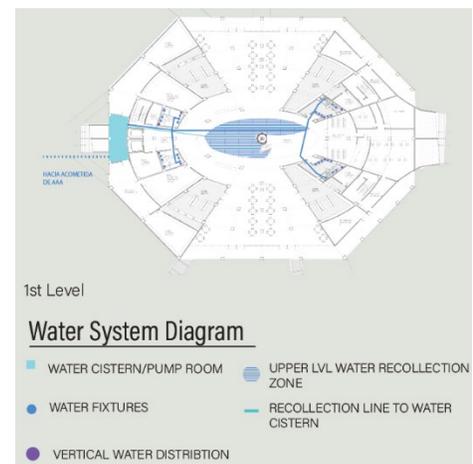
Diagrama planta primer nivel con localización de cisterna, trabajado por el autor.
